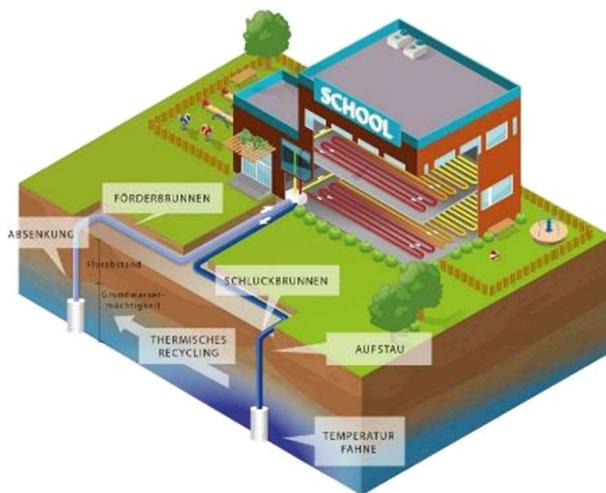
Der typische Aufbau einer Grundwasserwärmepumpe mit Förder- und Schluckbrunnen
